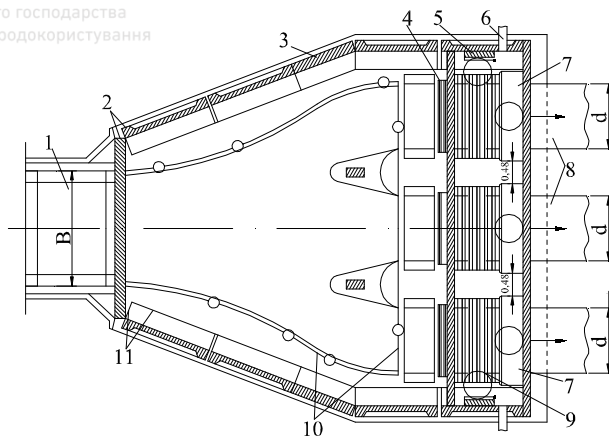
Вхідна камера дюкера із збірних залізобетонних блоків:
